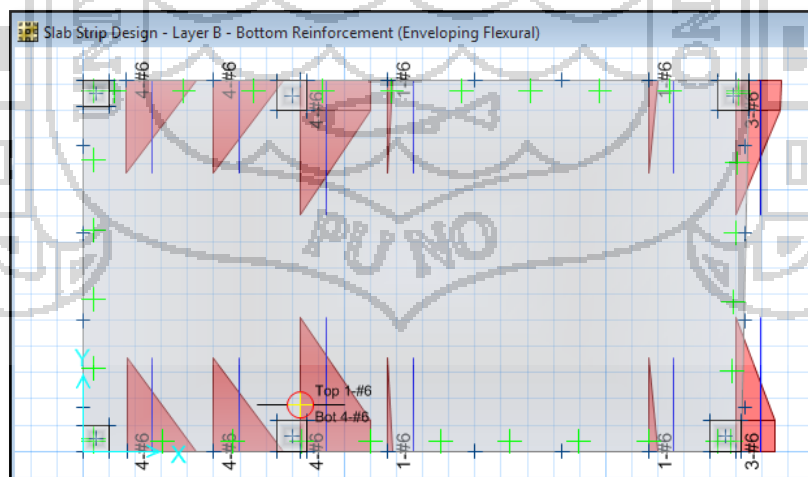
PLATEA 03 BLOQUE A, Acero Inferior; Franjas en Y-Y
